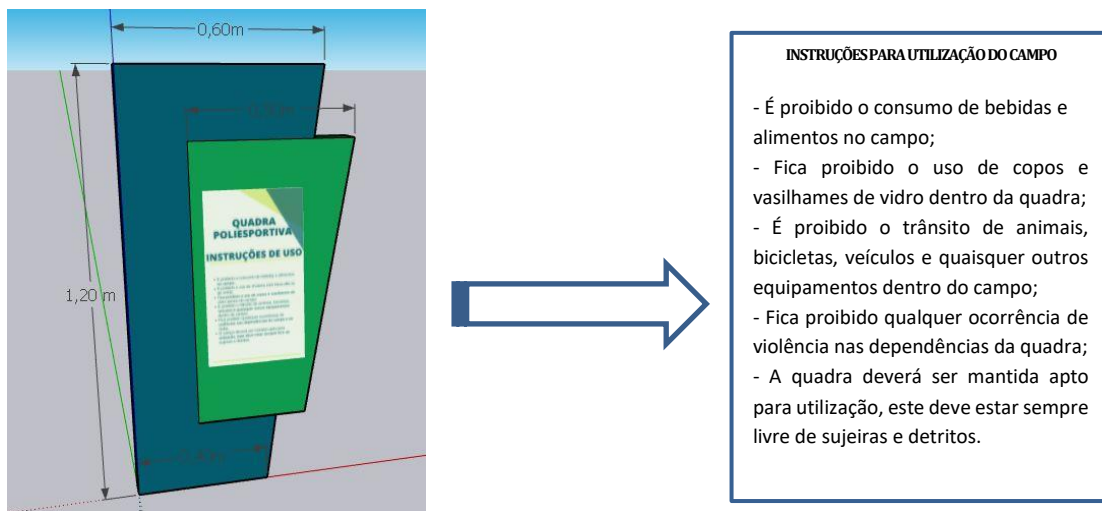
Detalhe Ilustrativo de placa de instruções (Fonte: Autora/2021)
